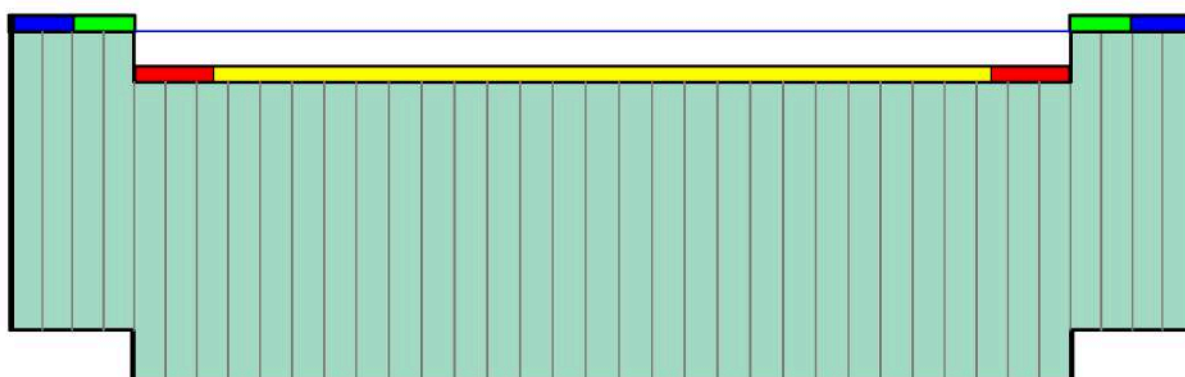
Zonas de división de la viga de coronamiento para determinación de armaduras. Fuente: Elaboración propia.
